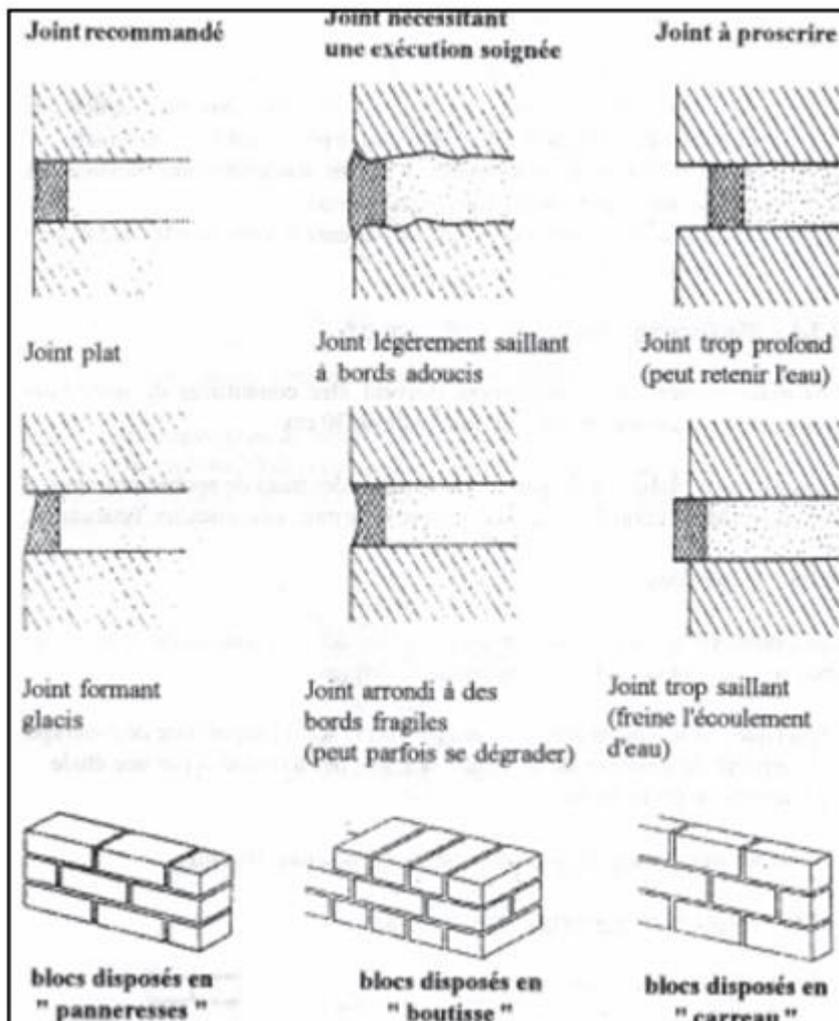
Elévation des murs d'une construction en adobe. (Source: CRATerre, "Construire en terre, P122)
